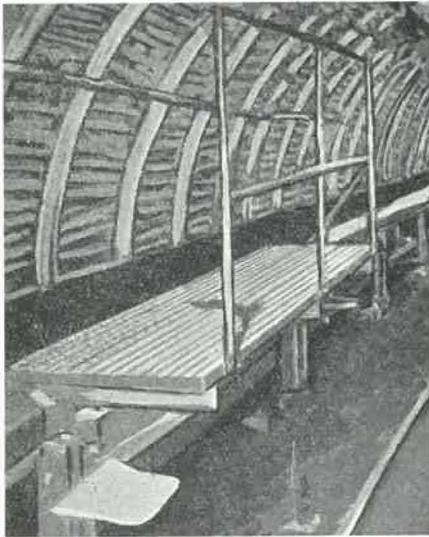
Plancher à hauteur de la courroie pour faciliter la montée et la descente.
